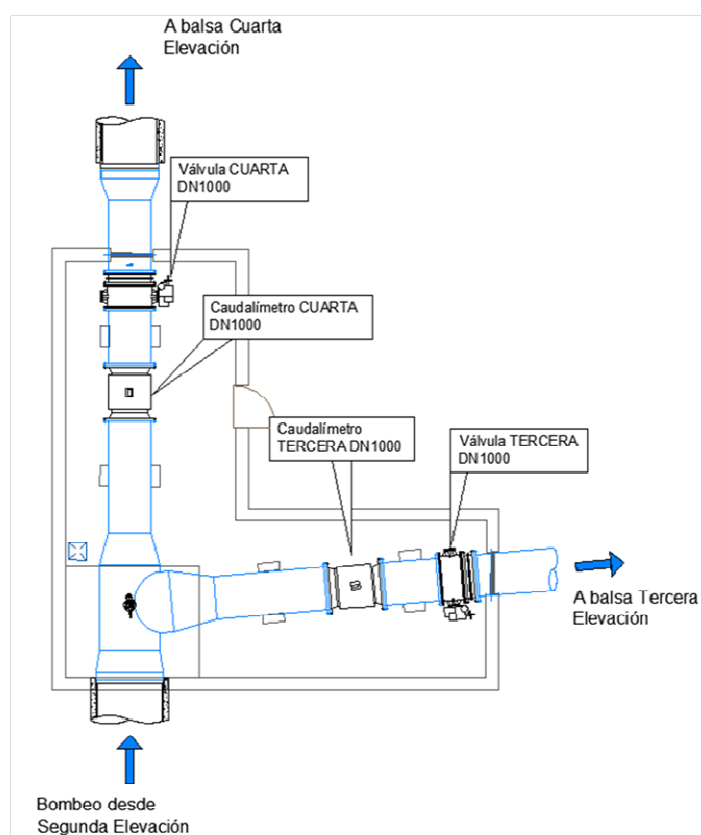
Plano en planta de la arqueta de derivación situada junto a la balsa de la Tercera Elevación
